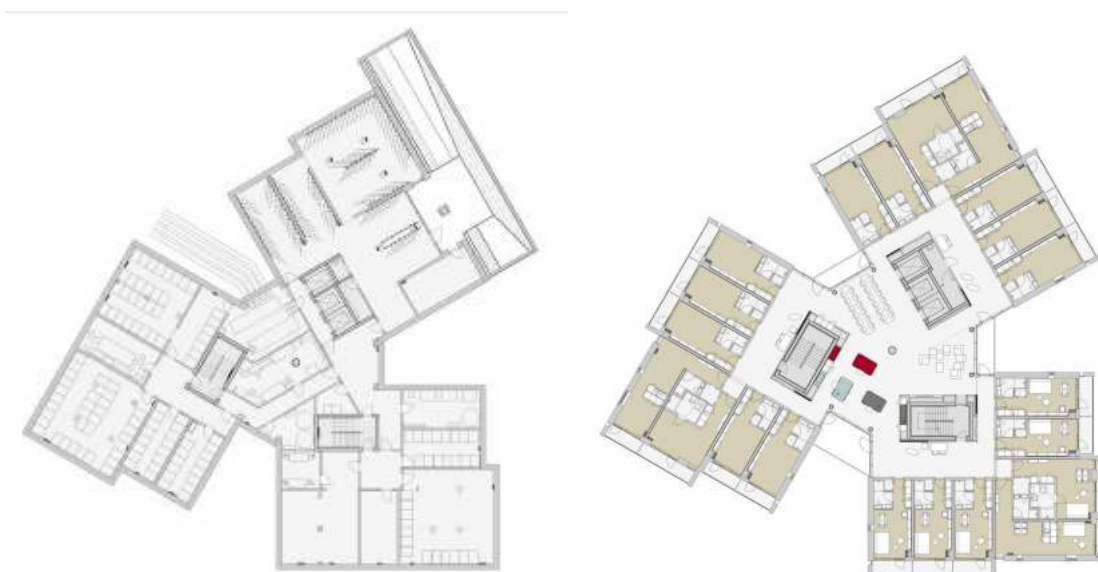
Planta do Pavimento Térreo, à esquerda. Planta do Pavimento Tipo, à direita. Moradia estudantil C.F. Møller, Dinamarca
